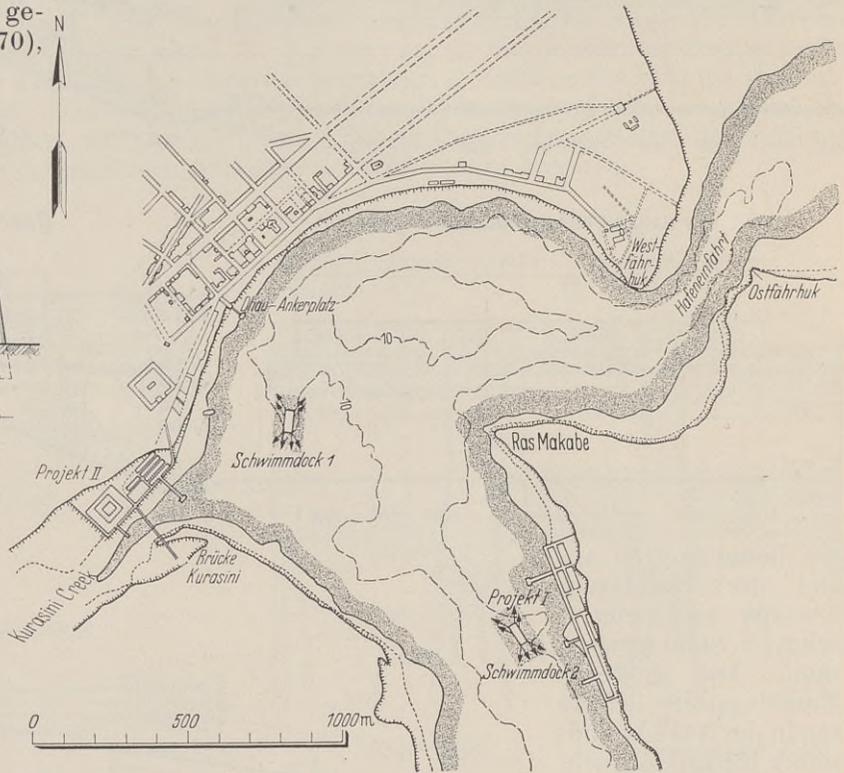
Lageplan von Daressalam mit Erweiterung.
